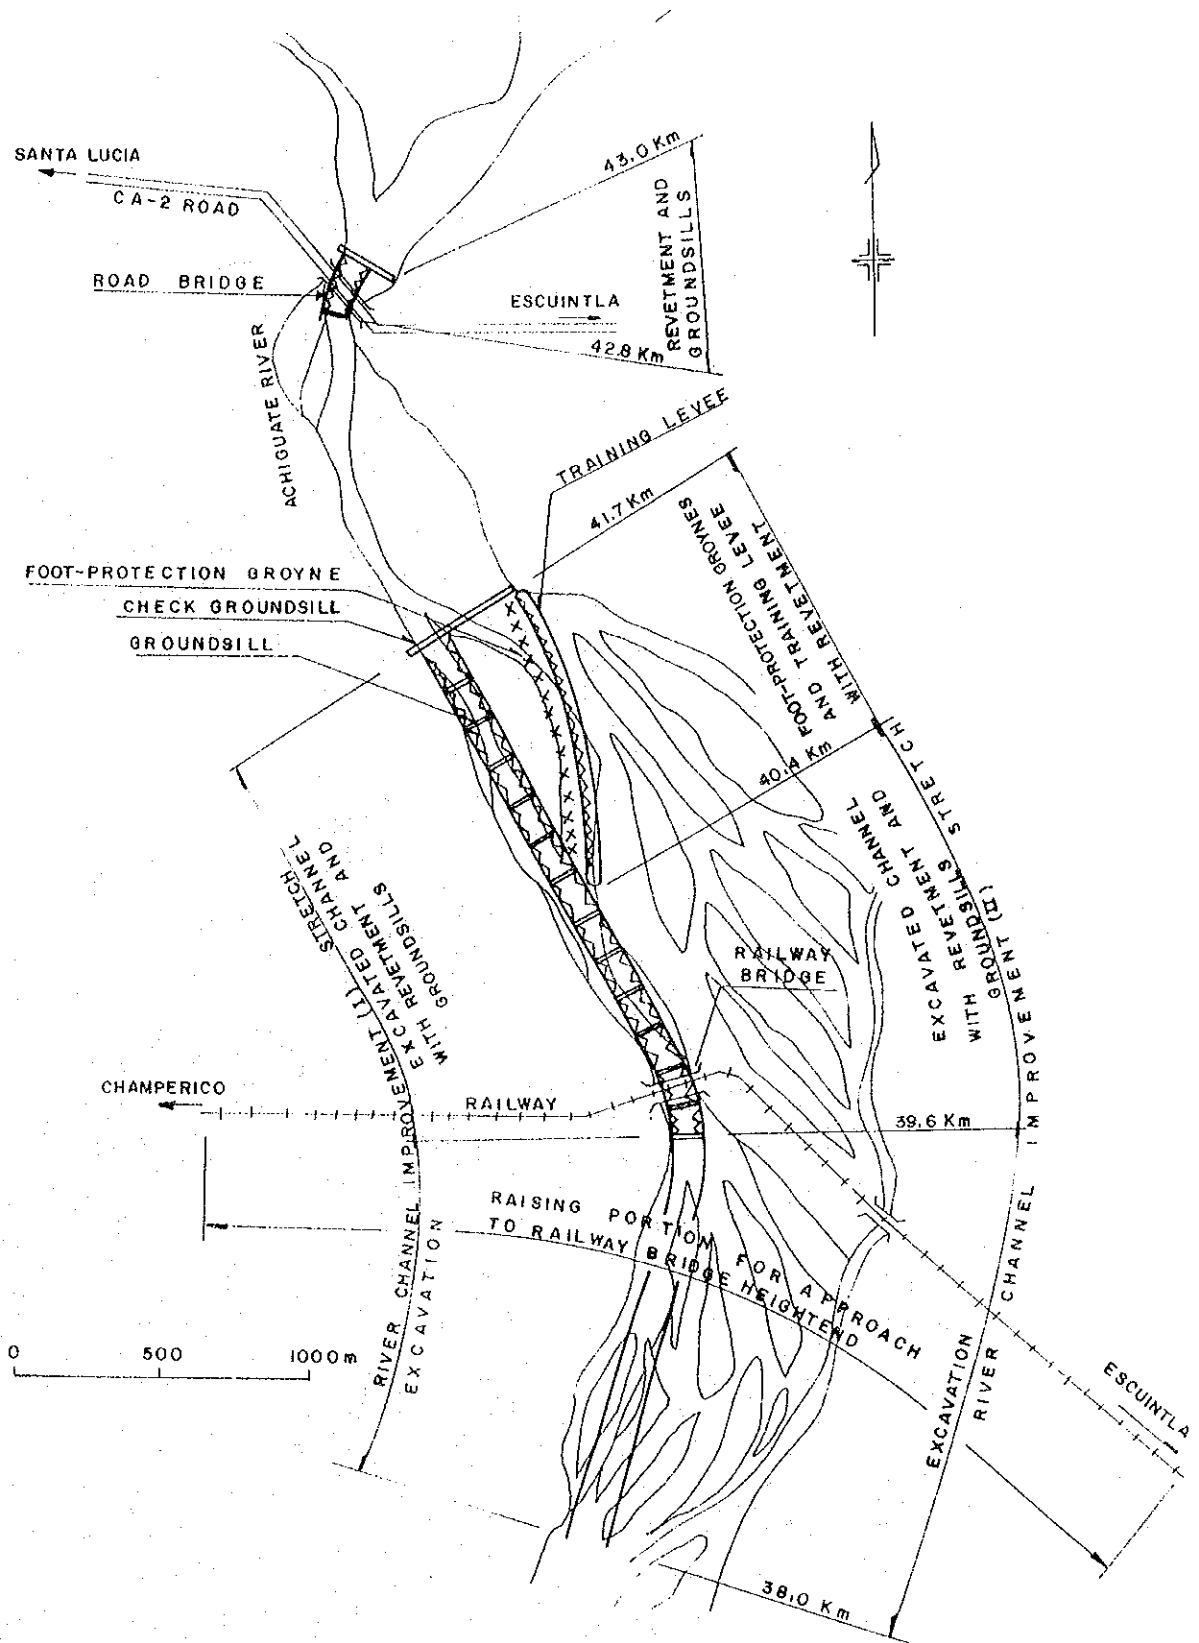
(1/4) UBICACION DE OBRAS ALTERNATIVAS (RIO ACHIGUATE, PROTECCION DE LOS PUENTES)
